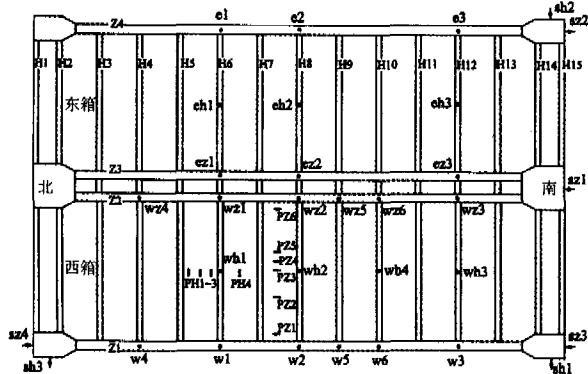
渡槽底部和支座位移计及底板混凝土应变片布置
